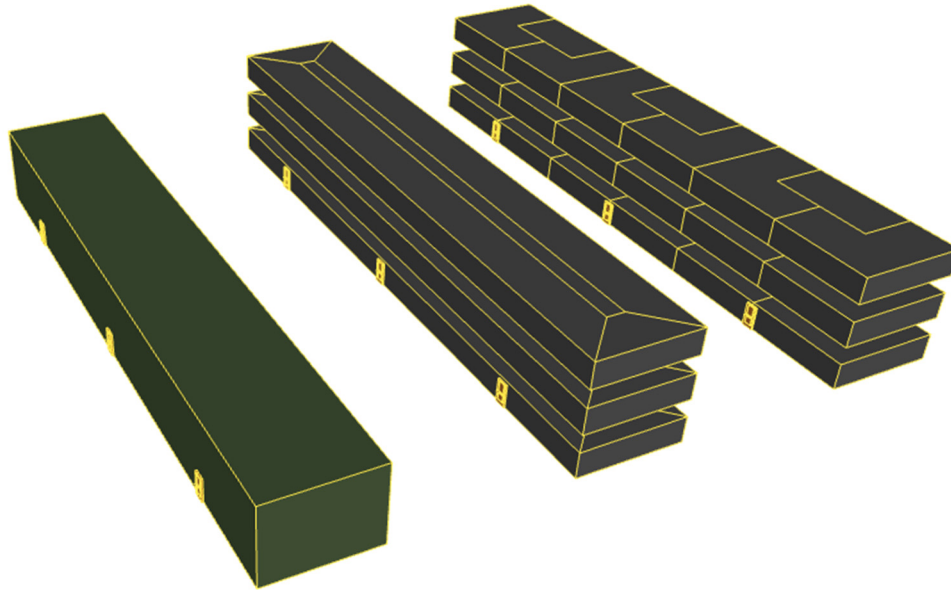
Unterschiedliche Zonierungsansätze für Mehrfamiliengebäude. Links: Einzonier. Mitte: Zonierung in Rand- und Kernbereiche. Rechts: Zonierung nach typischen Wohnungsgrundrissen.
